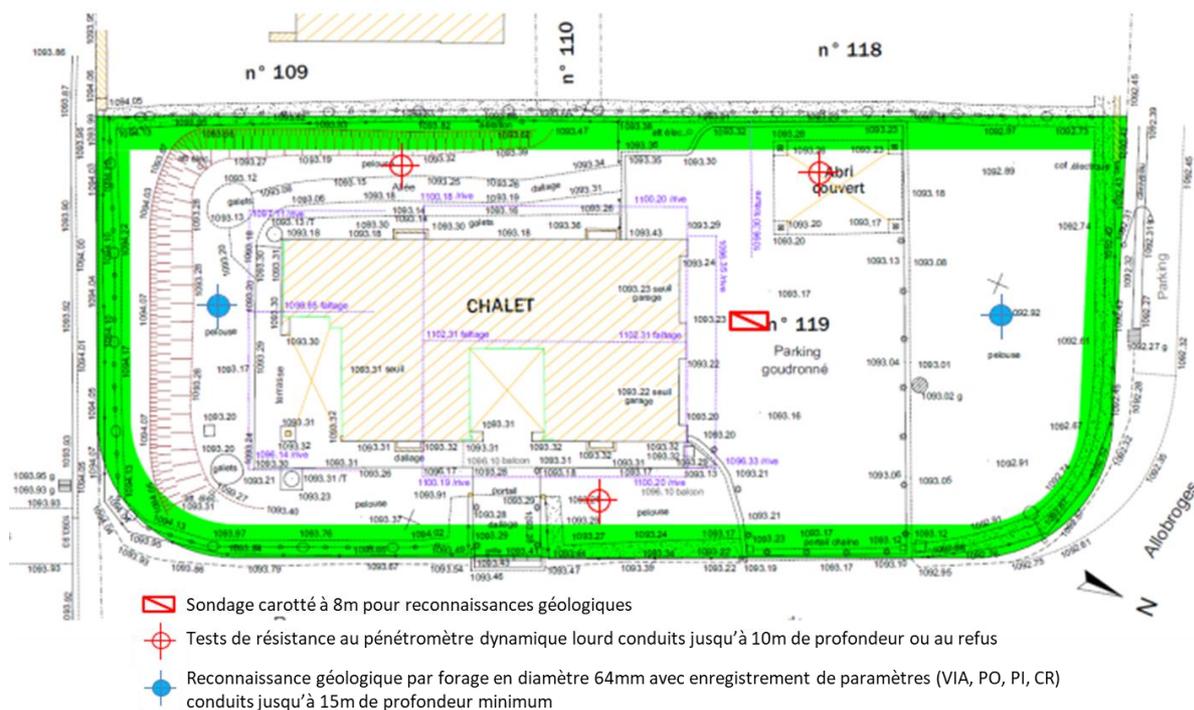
Plan prévisionnel d'implantation des sondages (source : 2 Savoie Géotechnique)
